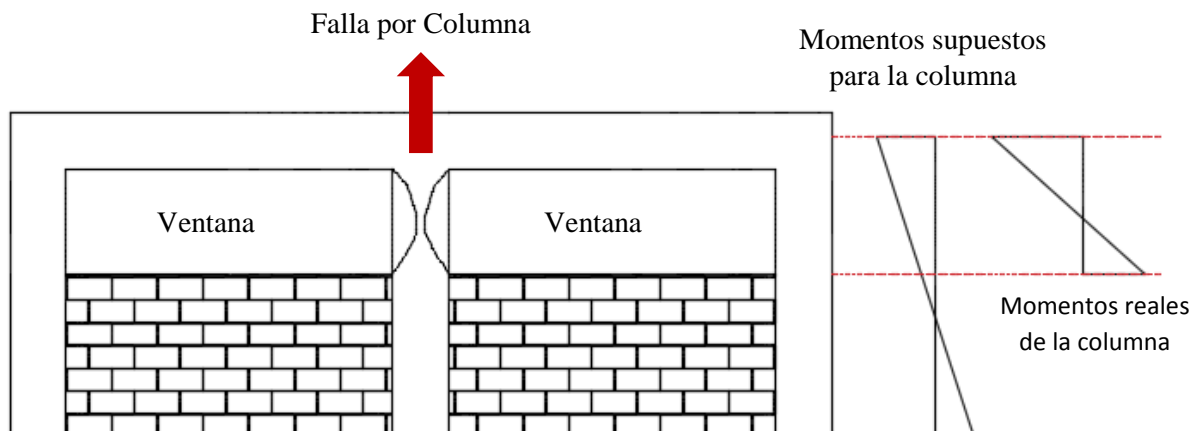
Interacción de muros de mampostería con elementos aporricados de concreto armado y fallas por columna corta. (Fuente propia)
